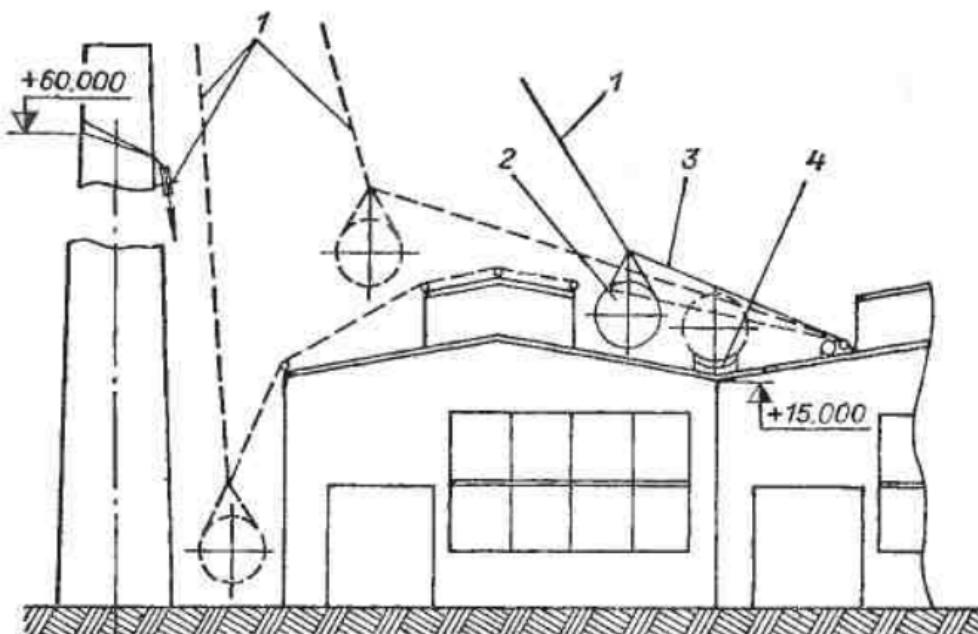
Монтаж паросборника на кровле цеха полиспастом, увязанным за железобетонную дымовую трубу:
